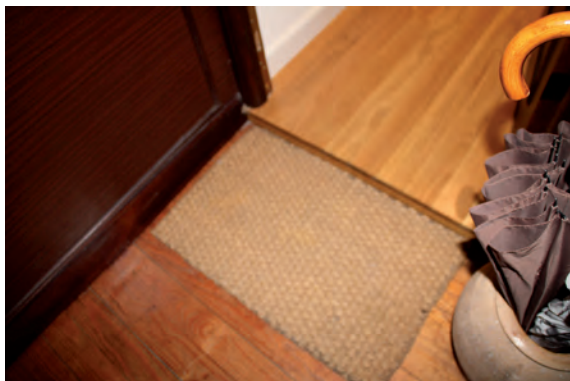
37. ESCALÓN EN INTERIOR DE VIVIENDA
